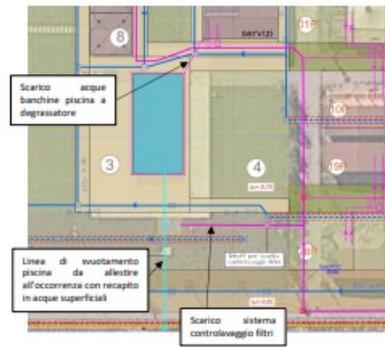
Stralcio planimetria di progetto e reti fognarie zona piscina.
